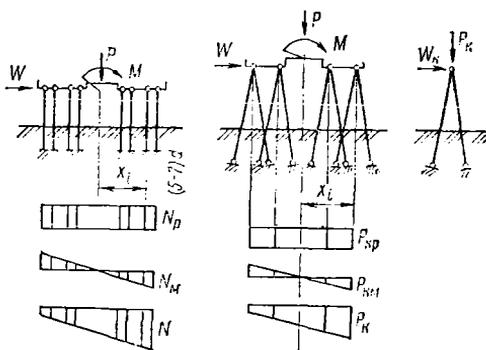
Схемы нагрузок на свай вертикальные и наклонные
